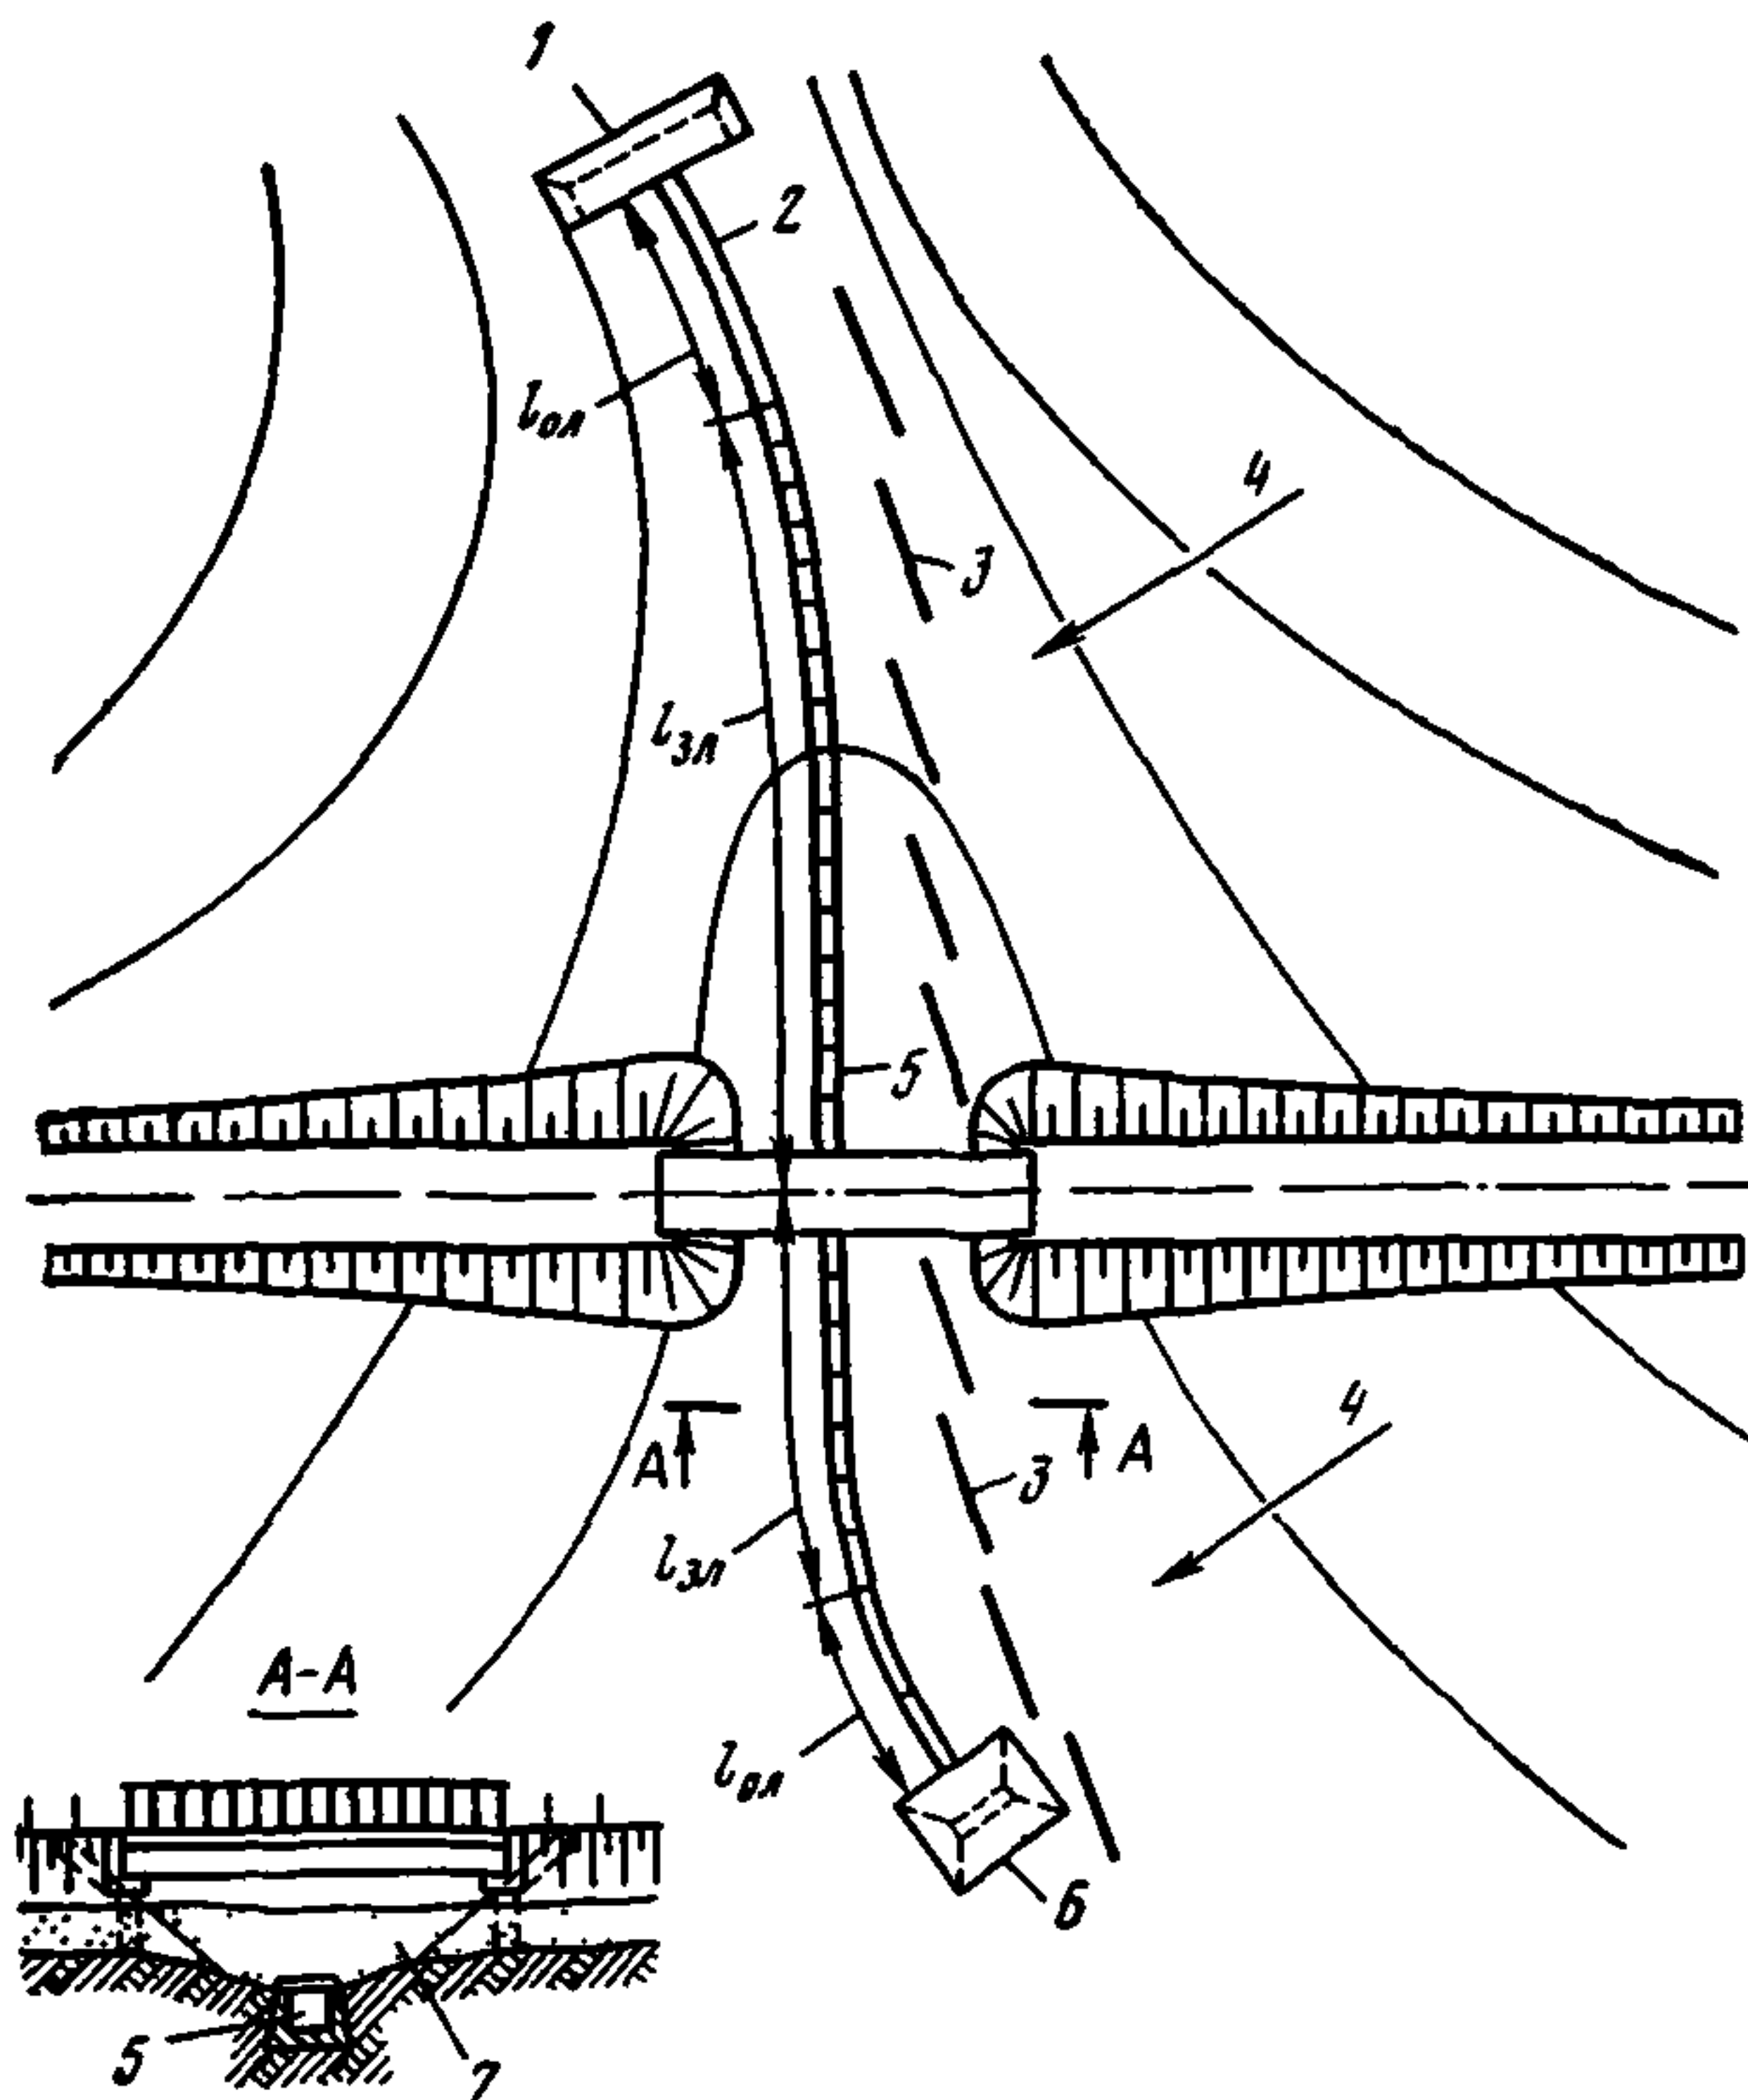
План расположения утепленного железобетонного лотка для безналедного пропуска водотока под мостом:
